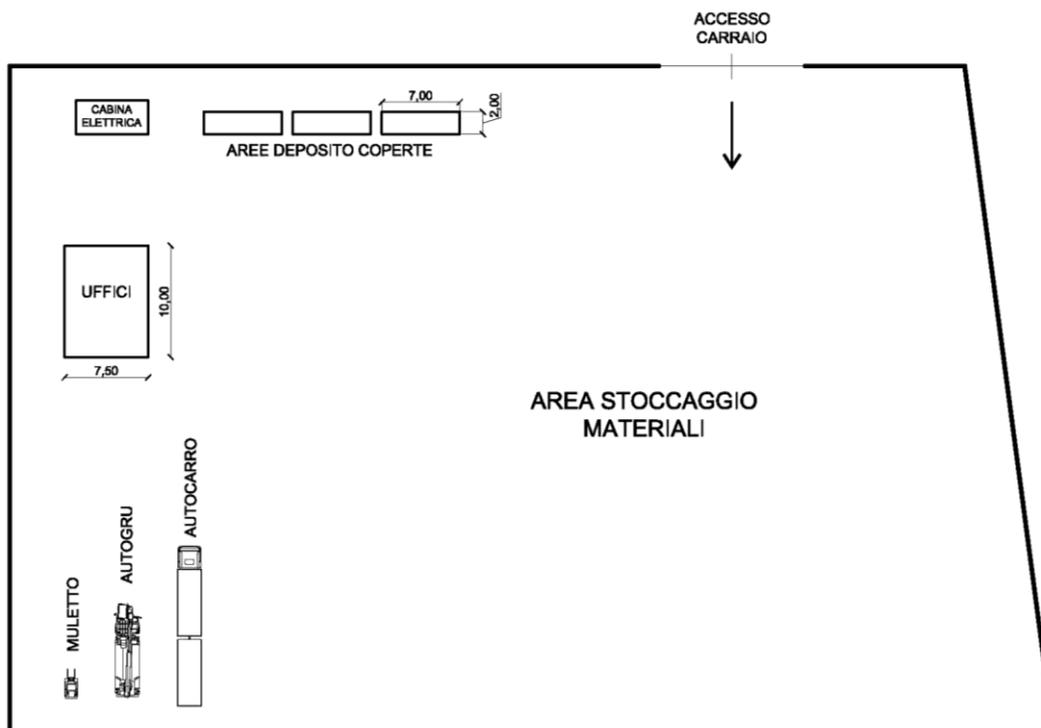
Pianta tipo Area Centrale (Campo Base)
